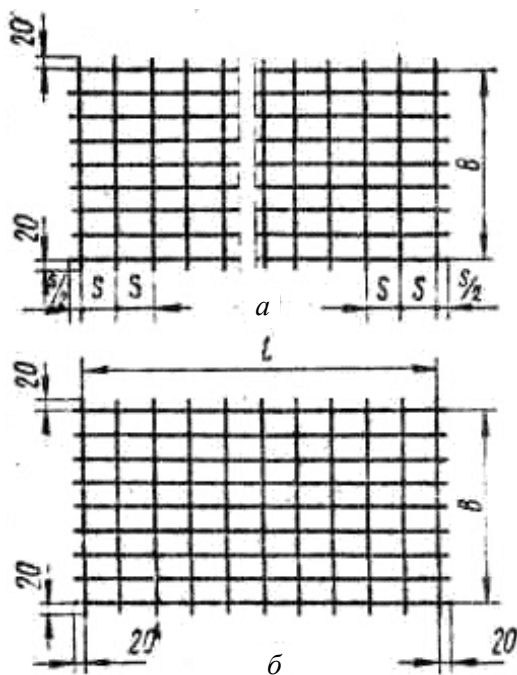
Рулонная (а) и плоская (б) сварные сетки армирования железобетонных конструкций
